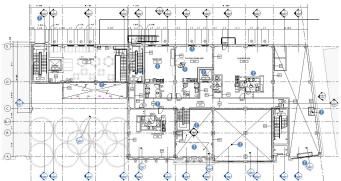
Site Plan Gedung Snowdon Towers (Sumber: Dokumen PT.Razasa Karya)
